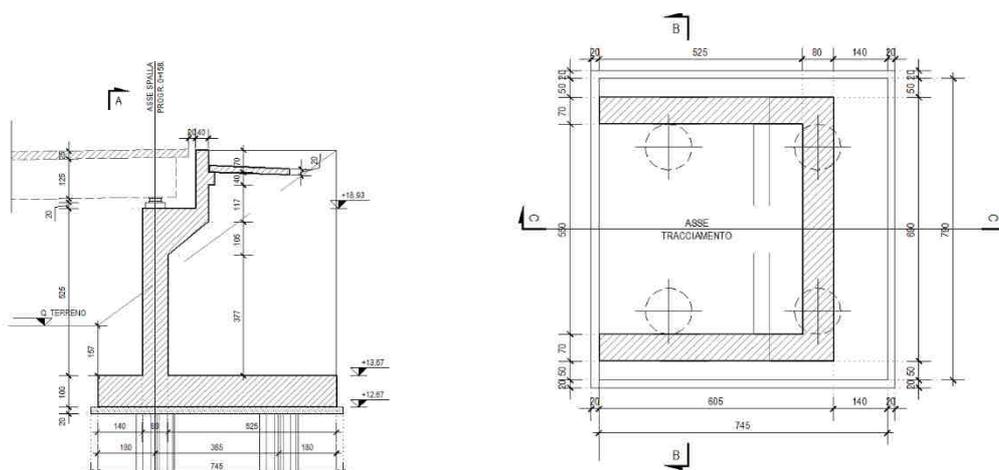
Spalla B sezione e pianta estradosso fondazione - Ponte Rio Nou su viabilità S05
